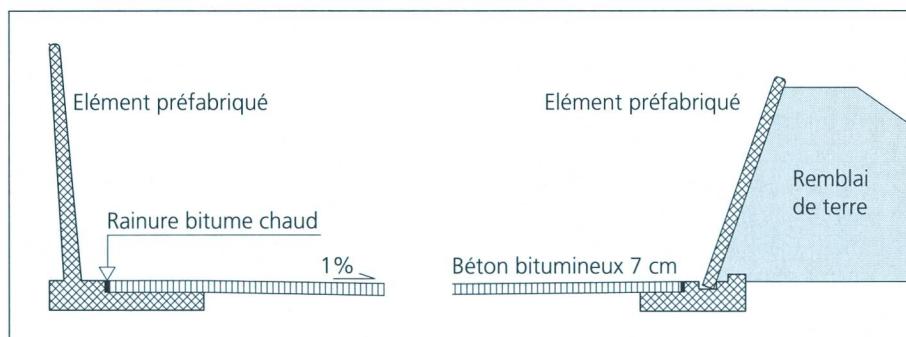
Pour que la paroi et la dalle soient reliées de manière étanche, il est recommandé de ne pas arrêter le revêtement au pied de la paroi, mais de le faire passer par dessus. Élément préfabriqué dégagé à gauche et élément préfabriqué type Traunstein à droite.
